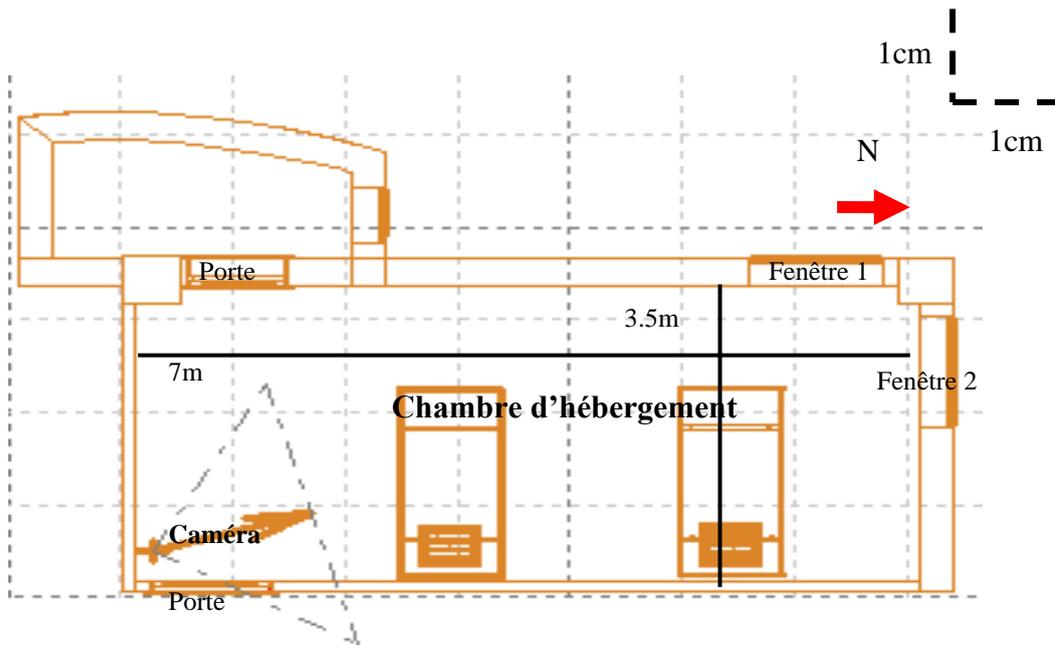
plan de la pièce étudiée (Auteur, 2021)
